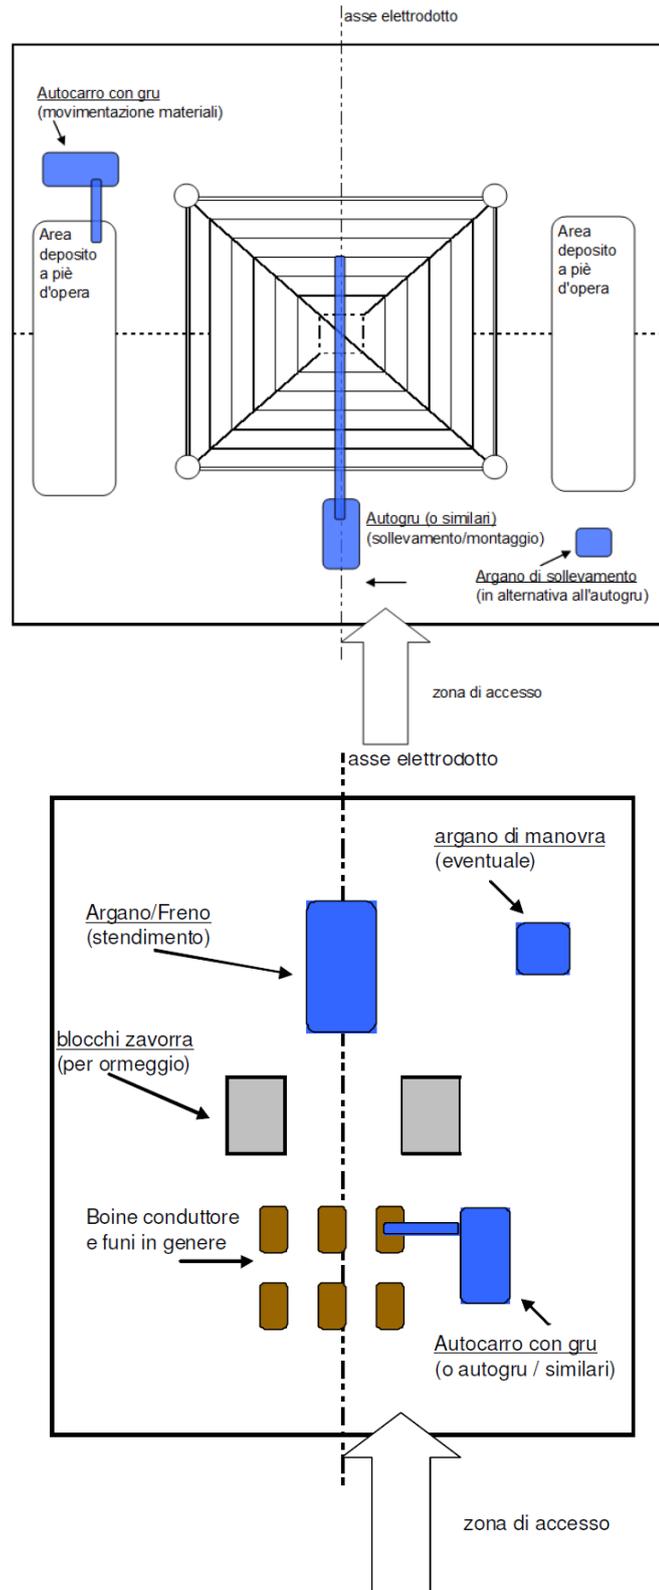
Planimetria tipologica dell'area di cantiere per il montaggio del sostegno
